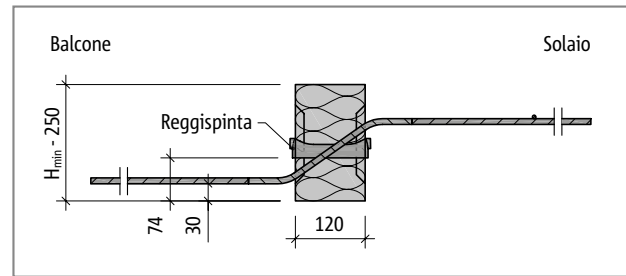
Schöck Isokorb® tipo da QXT70 a QXT90: sezione dell'elemento
